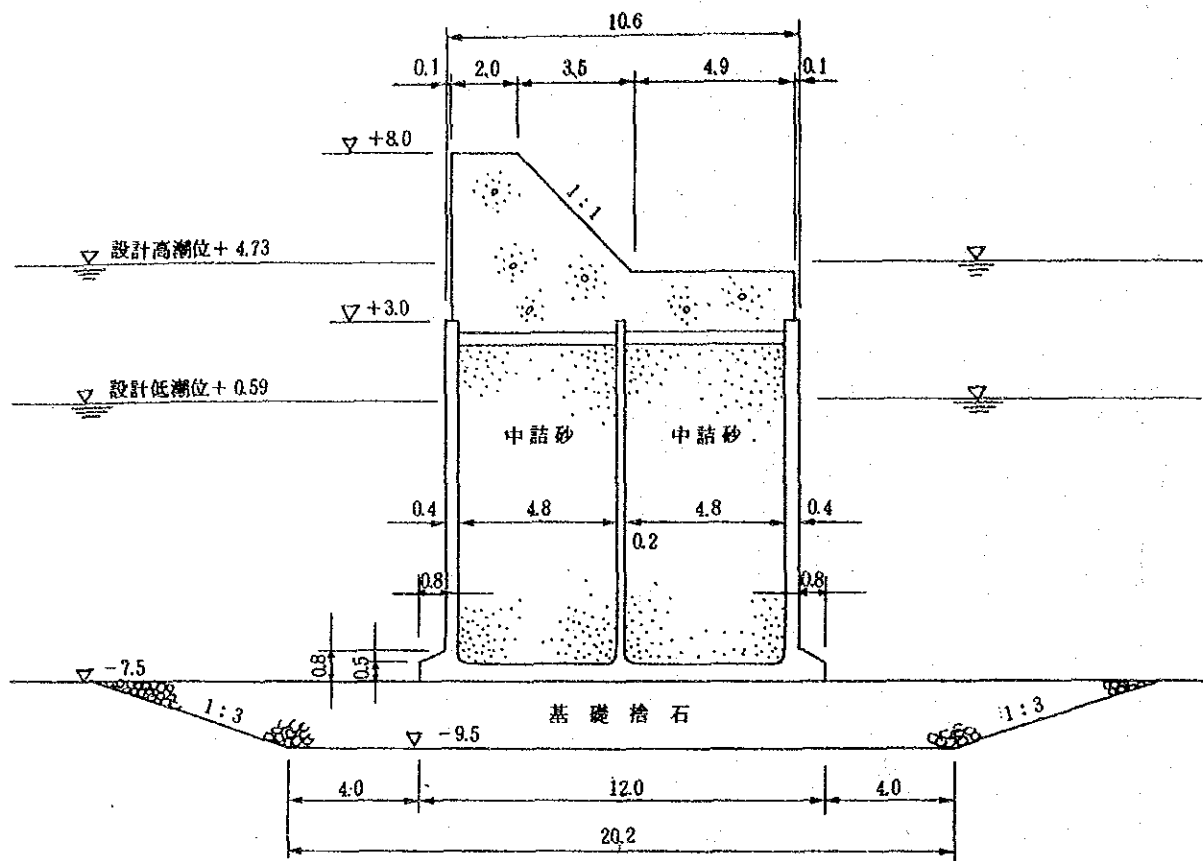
防波堤，先端護岸，標準断面图·平面图（比較案）
